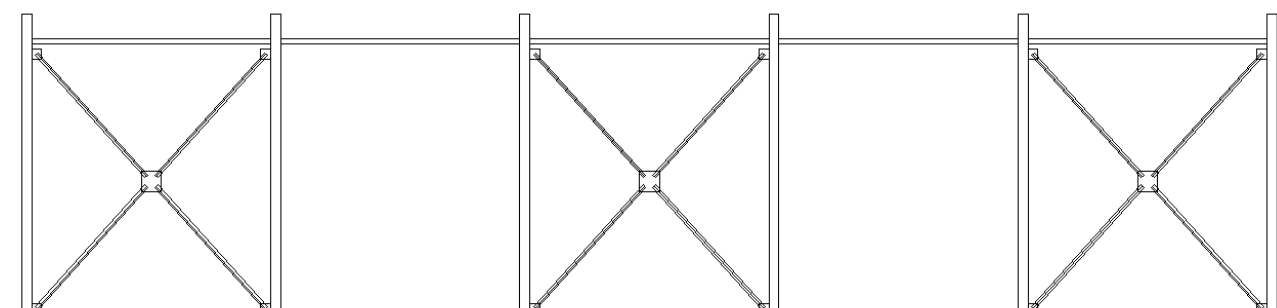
Estructura longitudinal rigidizada con contraventeos rígidos en cruz en marcos discontinuos.
